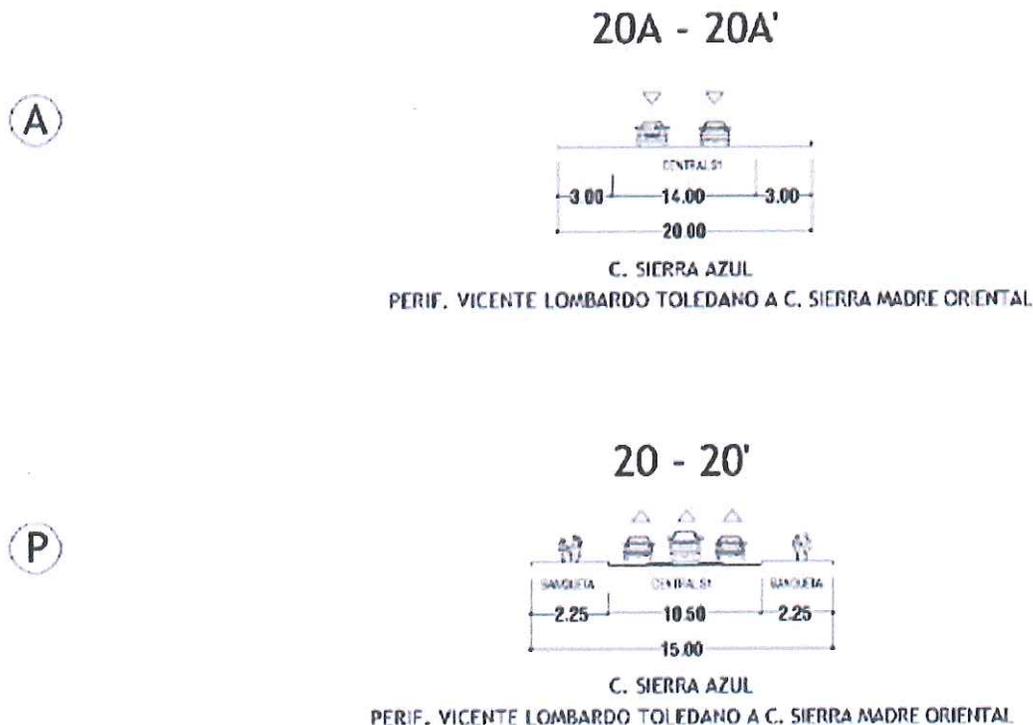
Sección vial propuesta para calle Sierra Azul. Fuente PDU 2040.
